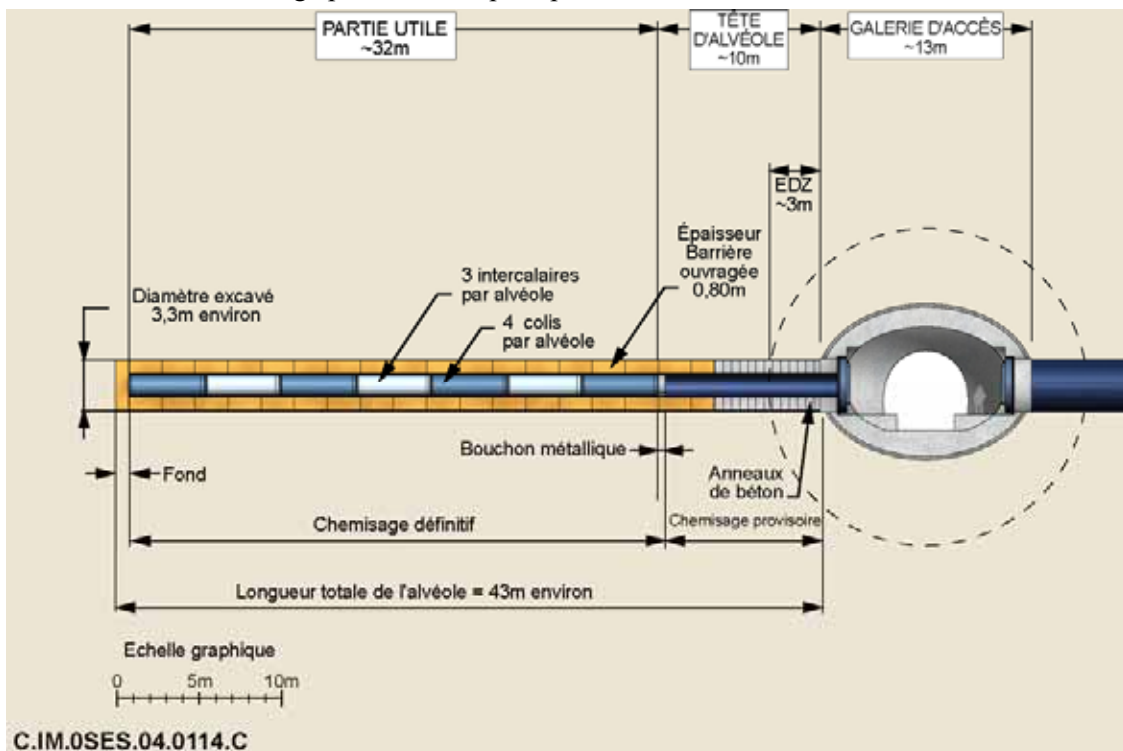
Coupe longitudinale de l'alvéole CU1
